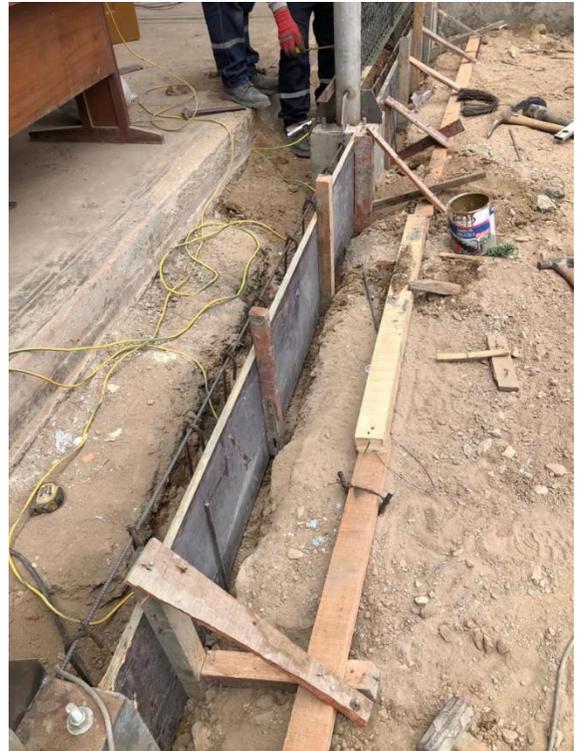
Excavación para el solado, zapatas y columnas $h=1.20\text{m}$.
